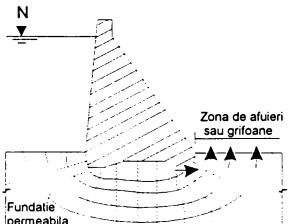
Baraje din beton. Zona de sufozii si afuieri.
